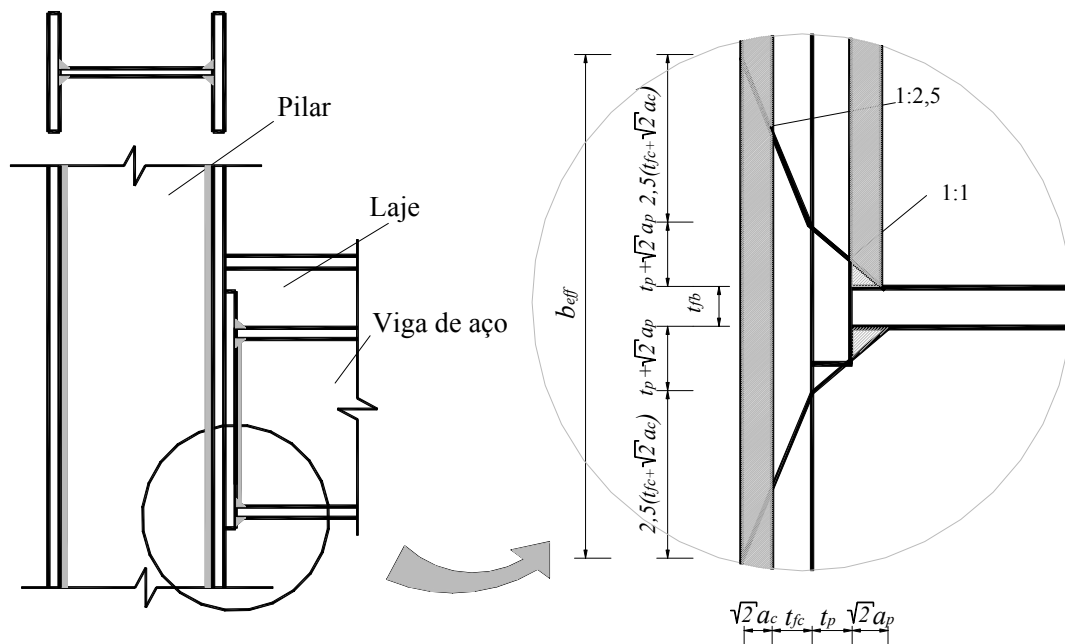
Altura efetiva da alma de um pilar soldado sob compressão
